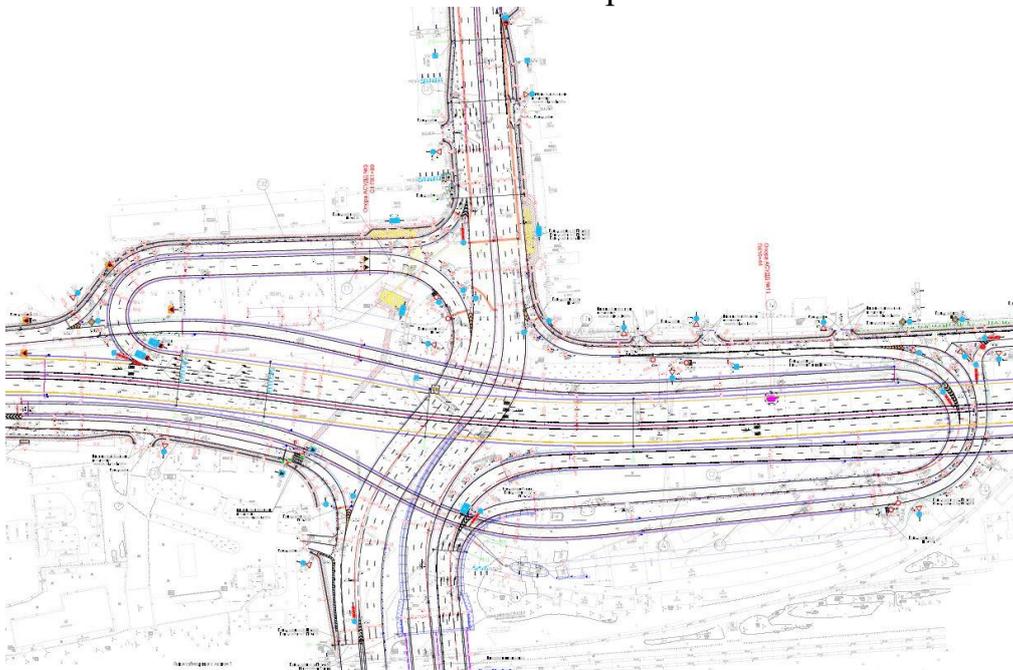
Мероприятия на перекрестке ул. Богдана Хмельницкого – ул. Писемского
